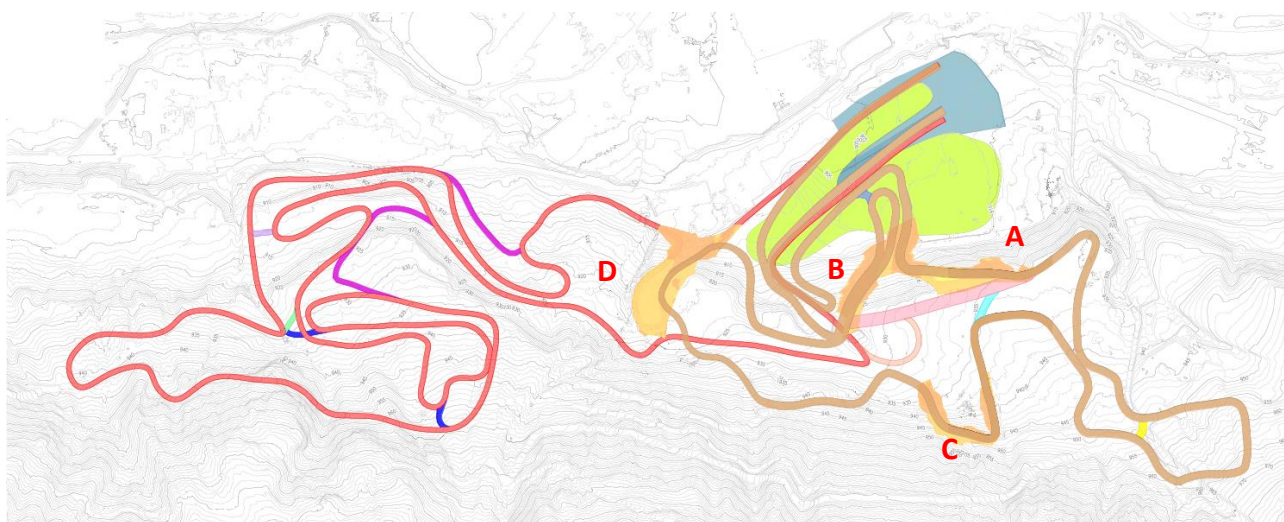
Planimetria sterri e riporto con indicazione zone di intervento - scala a vista
